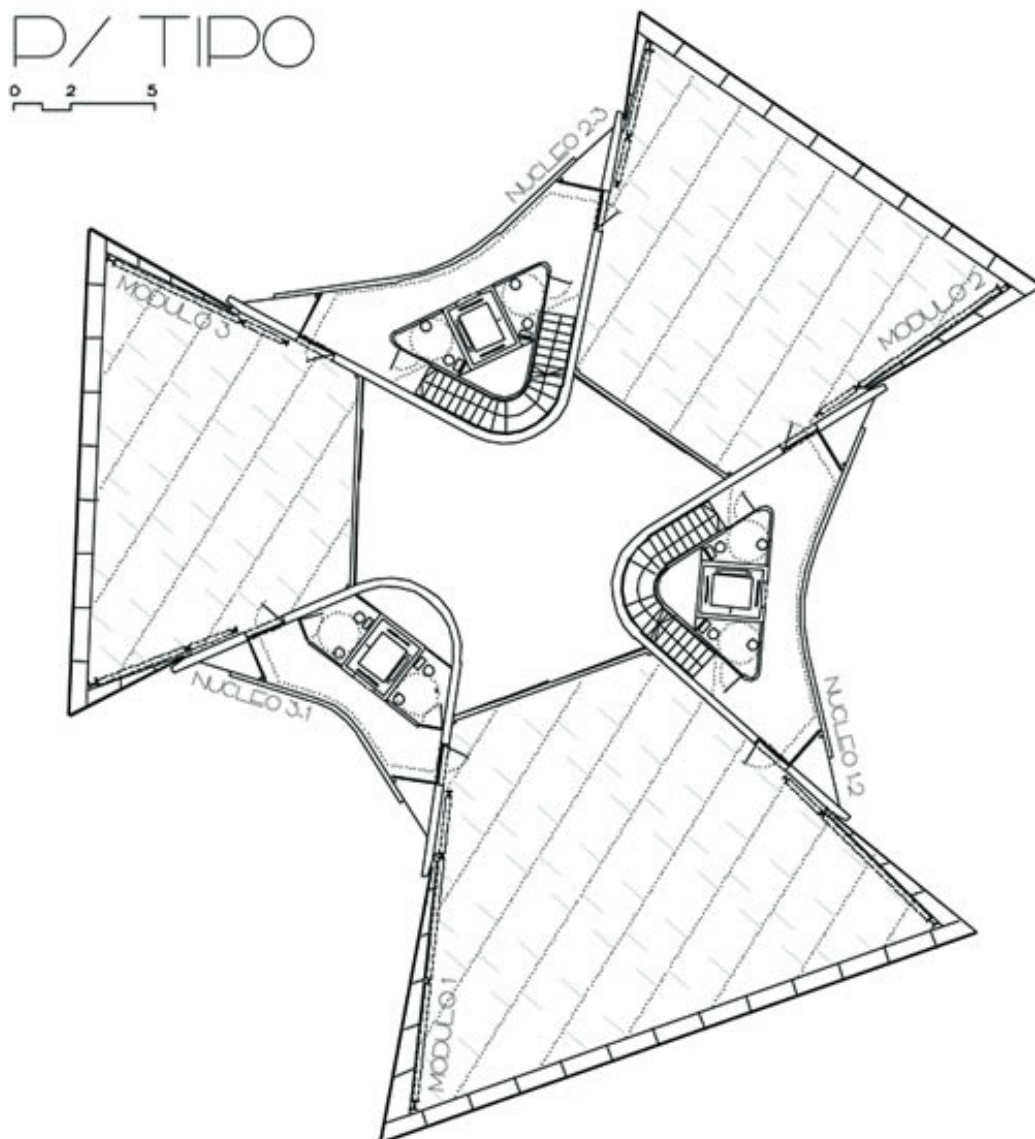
Planta tipo de La Torre Cube I. Documentos de Arquitectura nº 60. Revista del Colegio de Arquitectos de Almería.
